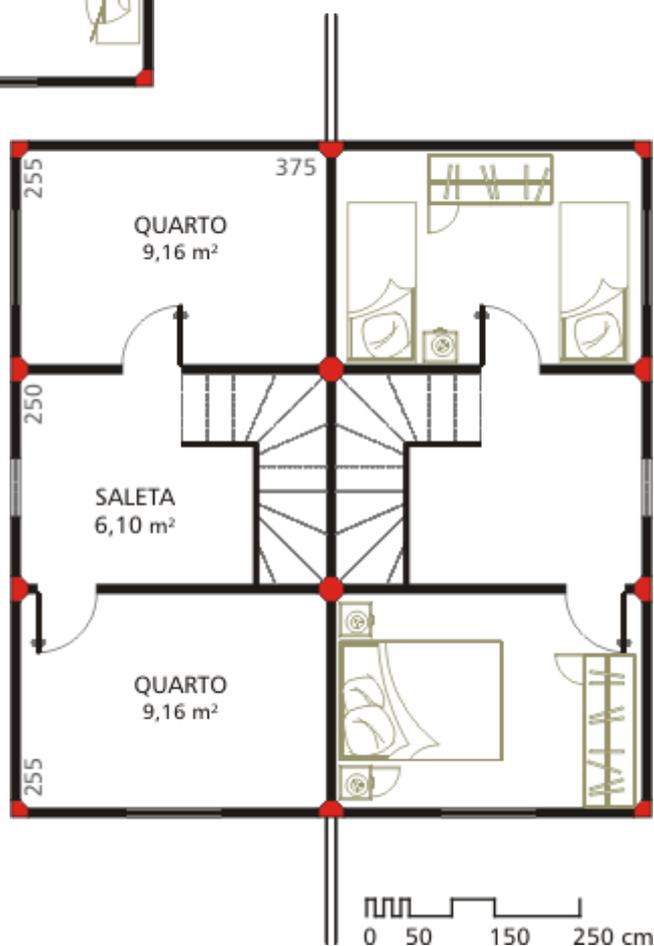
Planta baixa pavimento superior com layout proposto originalmente.
